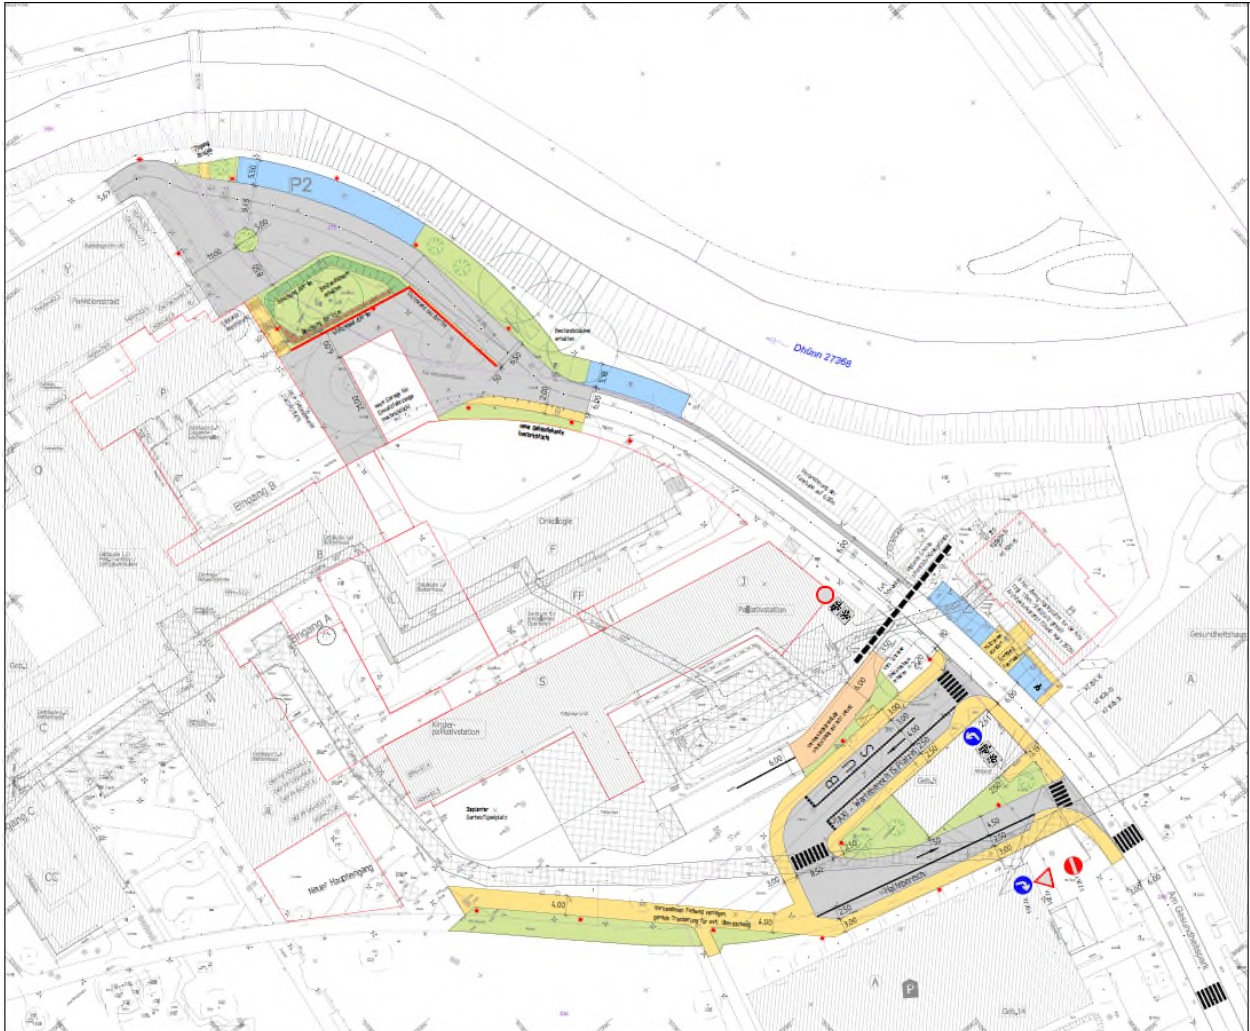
Außenanlagen Planung Vorfahrt und Liegenkrankenvorfahrt
